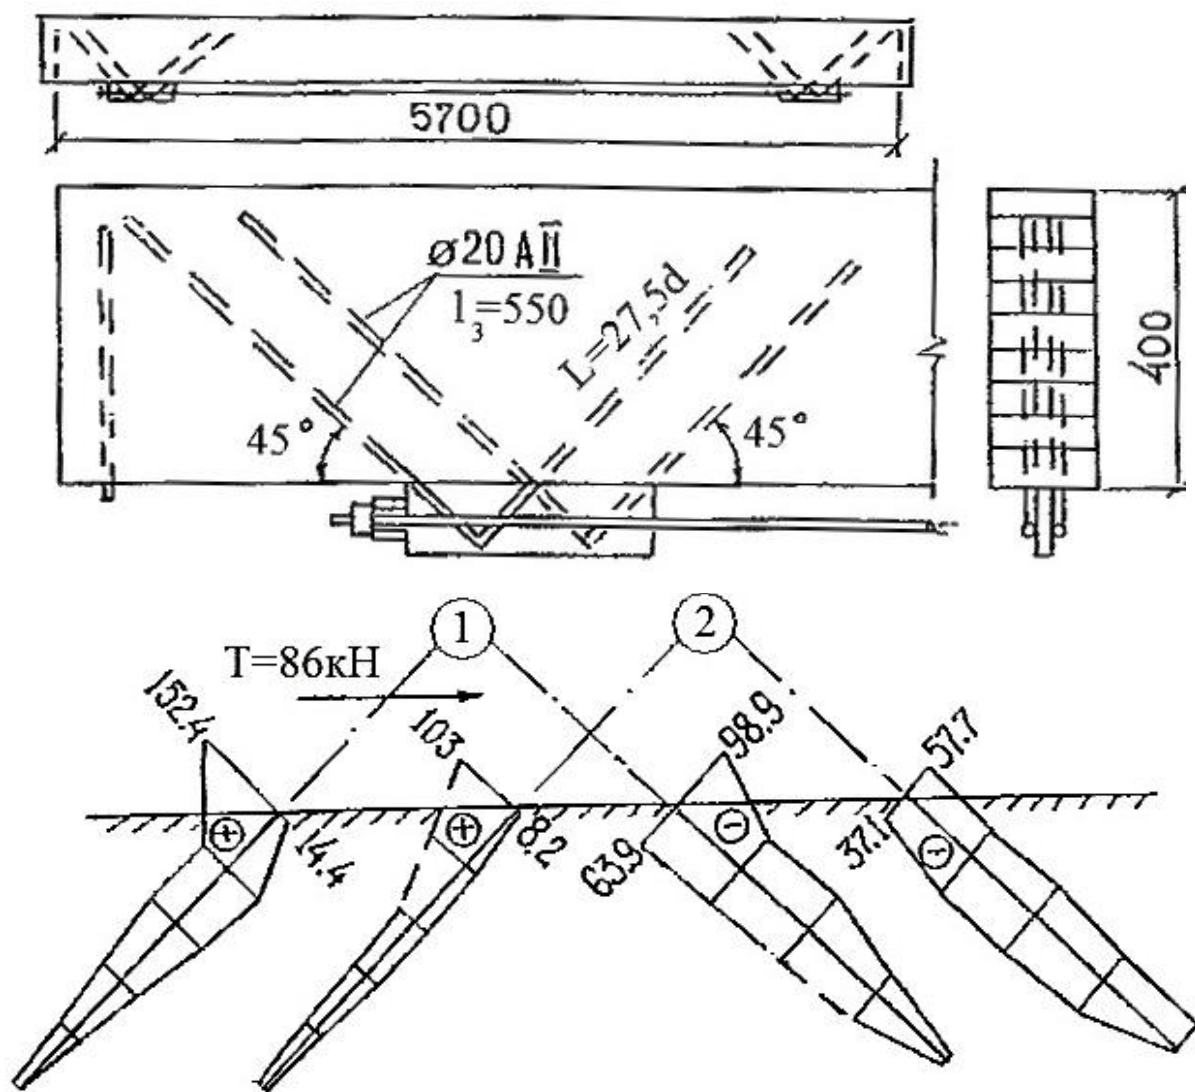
Крепление внешнего армирования дощатоклееной балки на V-образных анкерах. Схема балки и расположение анкеров. Напряжения в наклонных вклеенных стержнях V-образных анкеров
